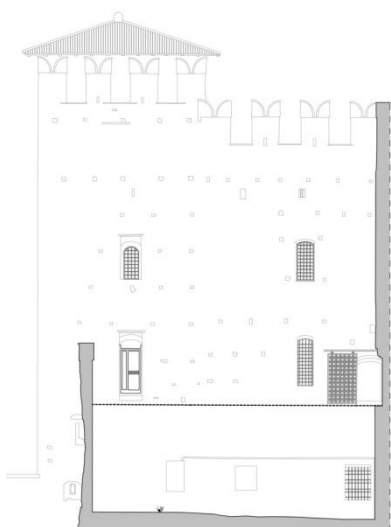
Prospetto sud ovest della Reggia e dalla torre nord ovest.
